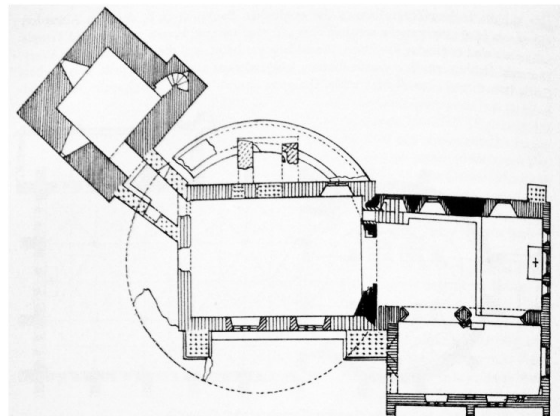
Grundriss, St. Michael, Garway, 12./13. Jh.
